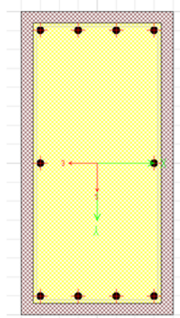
Section Designer’da Kolonun Mander Sargılı Beton Modeli.
